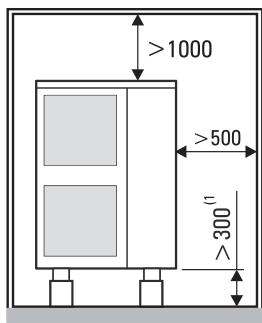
Spazio necessario per l'apparecchio esterno con protezione dal vento o copertura
